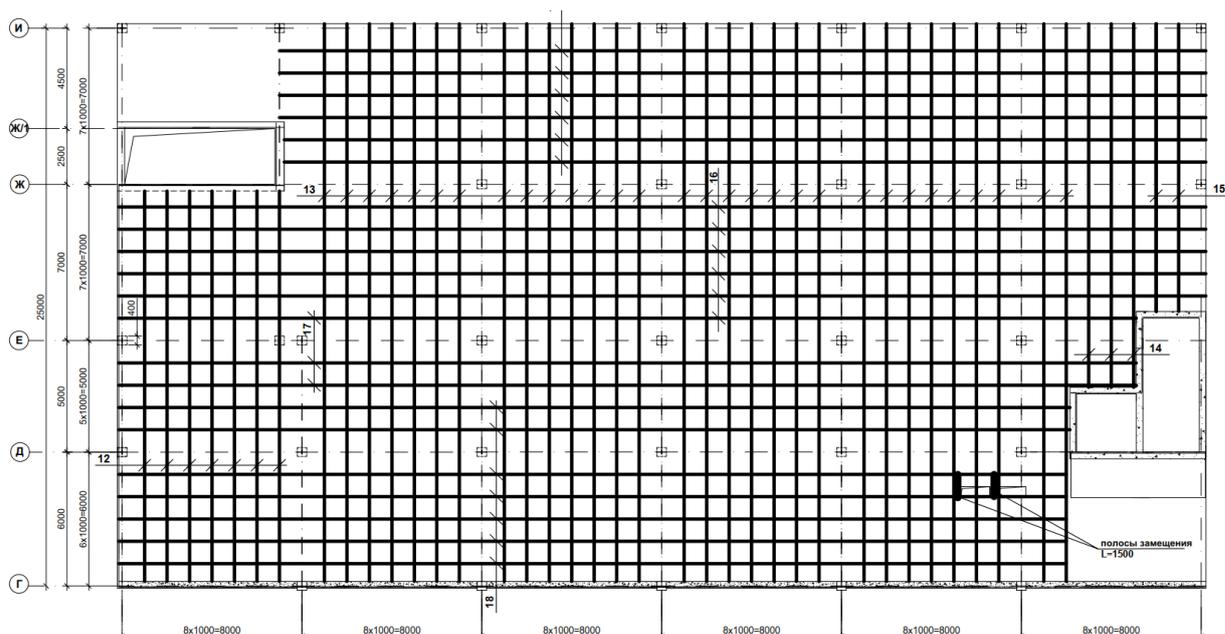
План расположения материалов усиления железобетонного перекрытия
